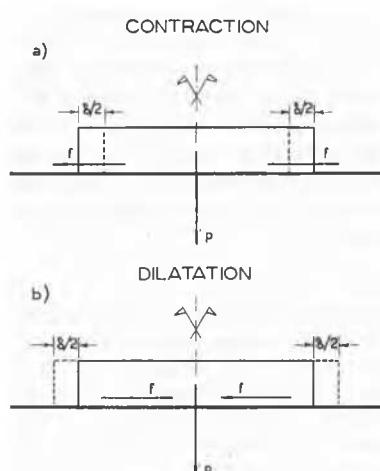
Cas de contraction et de dilatation sur plan horizontal
